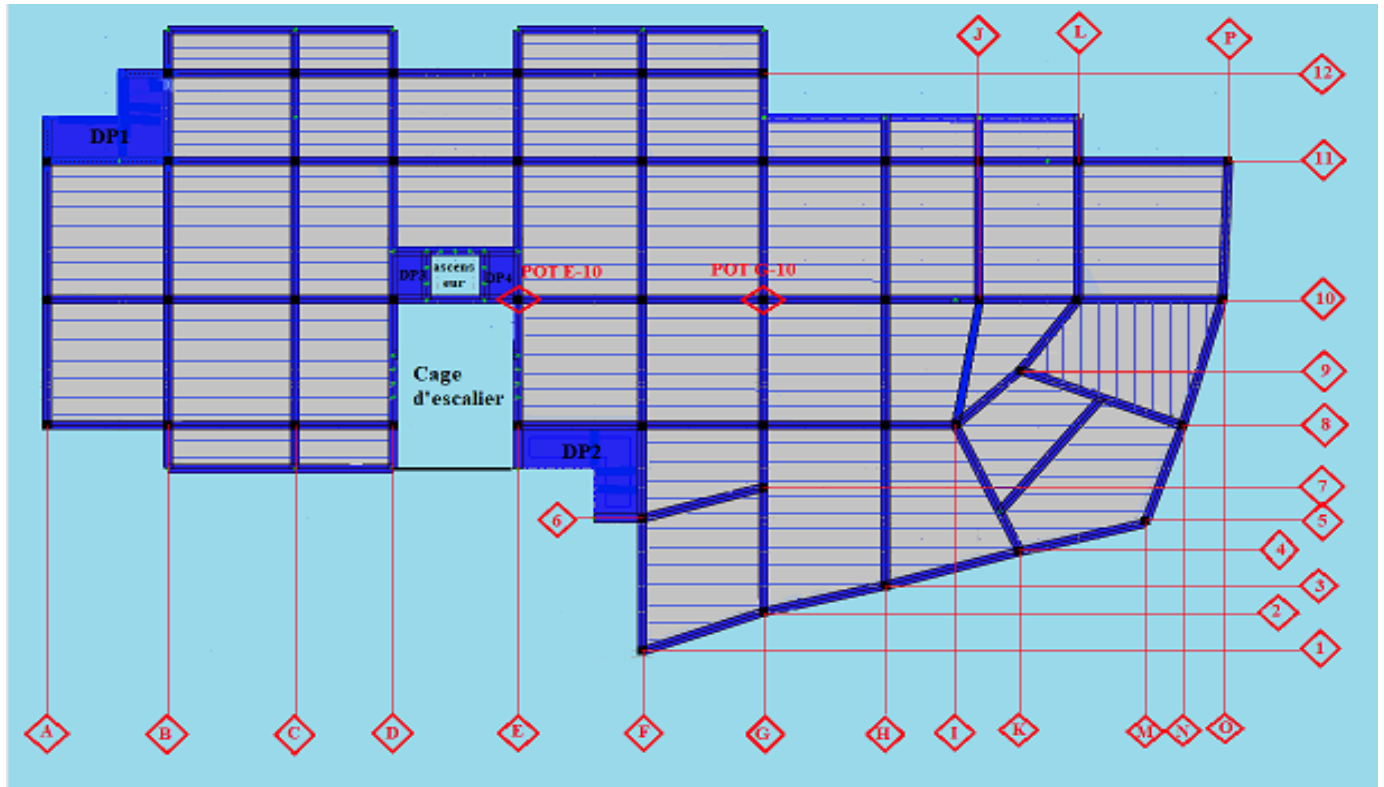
Plans de disposition des poutrelles et dalle pleines.
